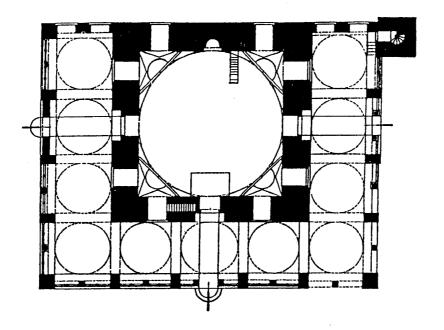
مسقط أفقي لجامع التي برمق بالقاهرة .
